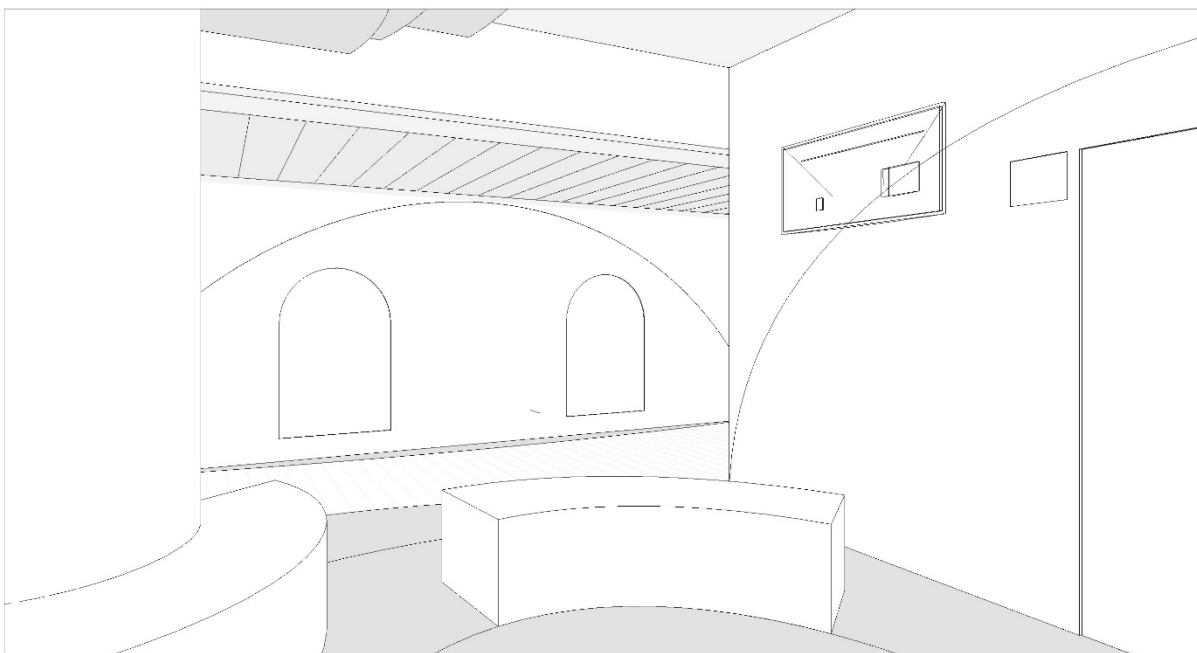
Vista de modelo tridimensional de estudo desenvolvido. Parede com painéis lúdicos e informativos. Fonte: Autora.
